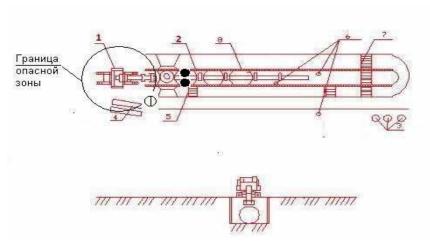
Схема производства работ по укладки стеклопластиковых труб 1 – экскаватор; 2 – защитный бурт; 3- смотровая площадка 4 – стеклопластиковые трубы; 5 – инвентарная лестница; 6 – рабочее место монтажников в момент перемещение труб; \bigcirc Местополфжение монтажника в момент строповки груза
